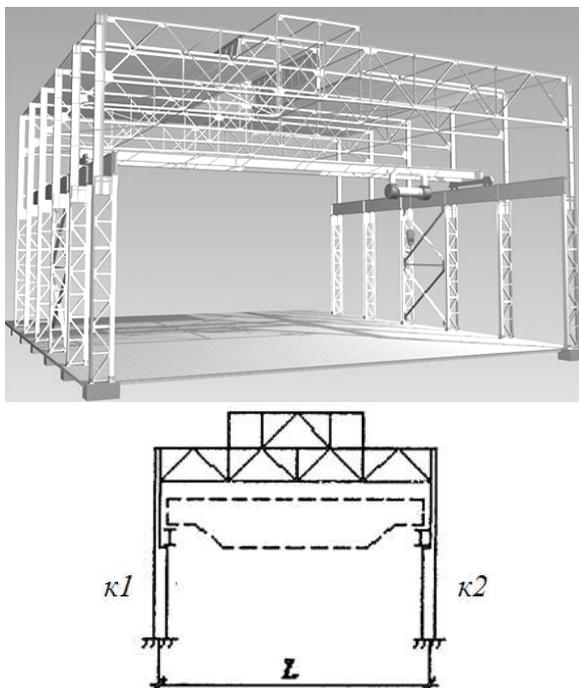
Каркас и поперечная рама однопролетного промышленного здания, работающие совместно с крановым мостом
